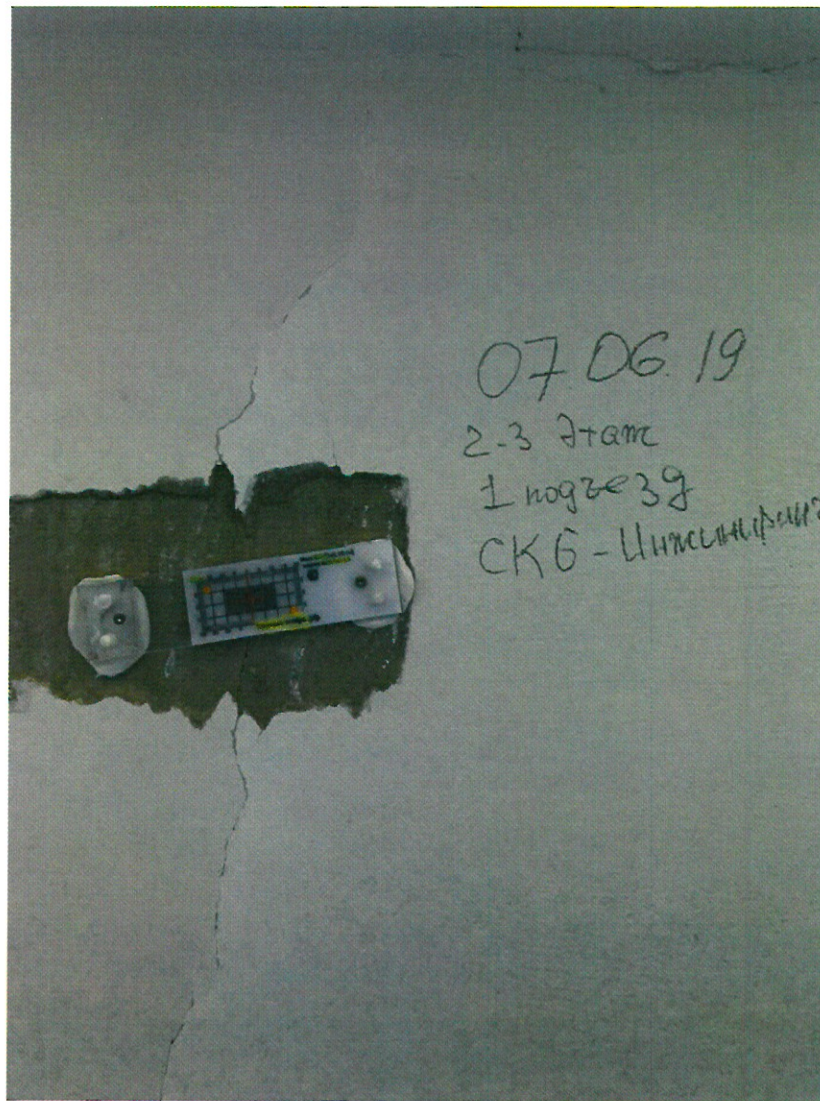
Установка маяка в здании на ул. Северная Застава, д.5 (1 подъезд, между 2 и 3 эт.). Трещина в поверхностном бетонном слое стеновой панели
